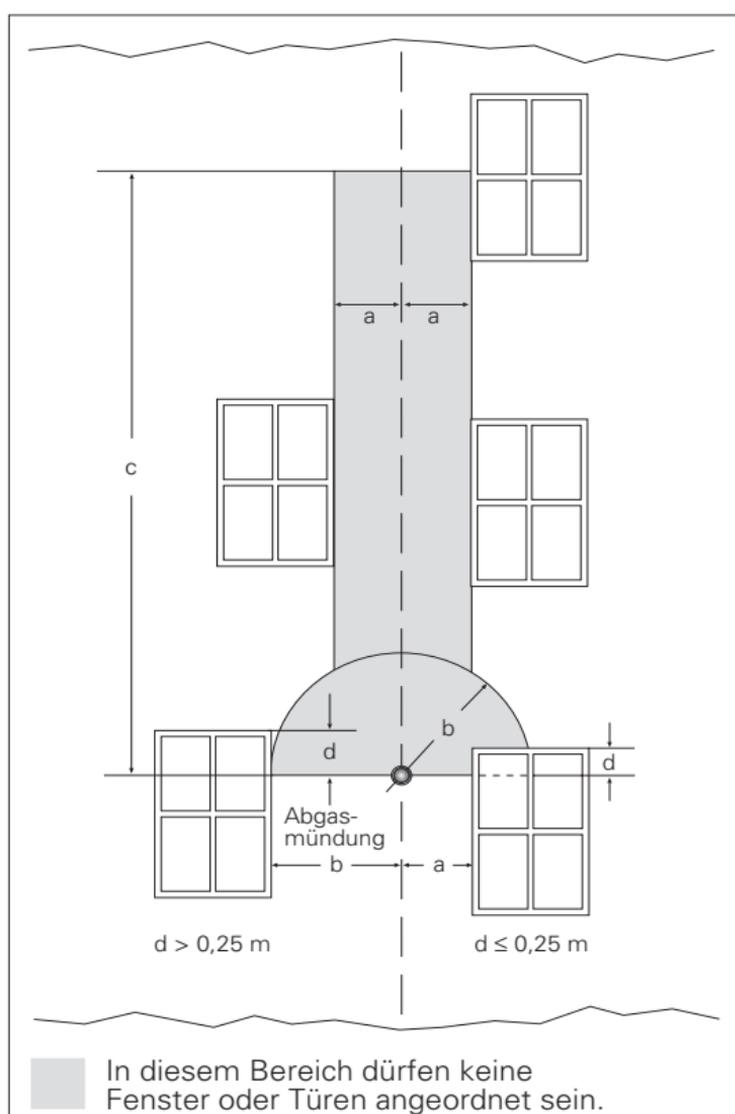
Mindestabstände einer einzelnen Abgasmündung zu Fenstern, die geöffnet werden können, oder zu Fassadentüren bei glatten Fassaden
